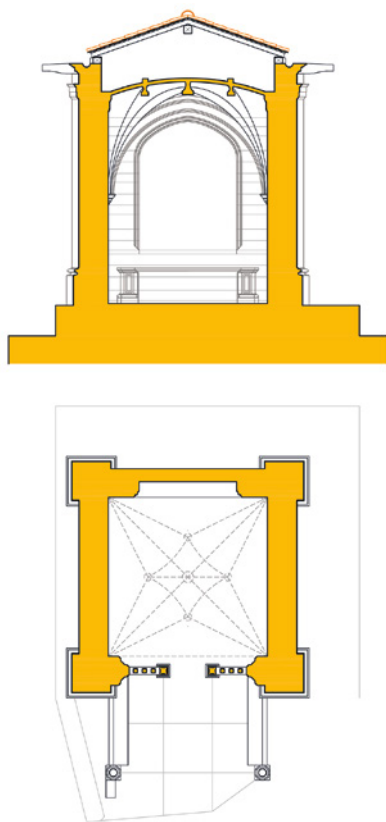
Torre de Don Miguel, Ermita del Cristo, planta y sección
